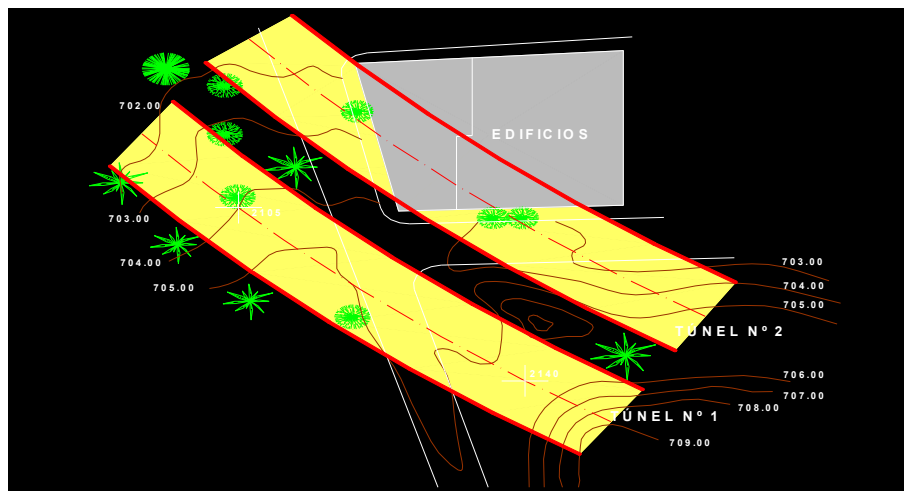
Esquema en planta de los túneles (fuente KRONSA).
